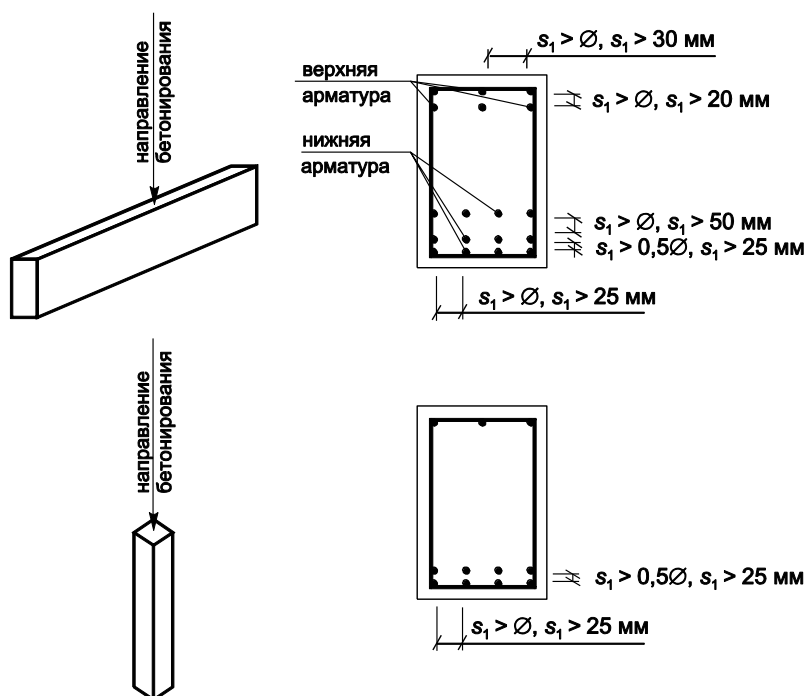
Минимально допустимые расстояния между продольными стержнями арматуры в зависимости от положения конструкции при бетонировании
